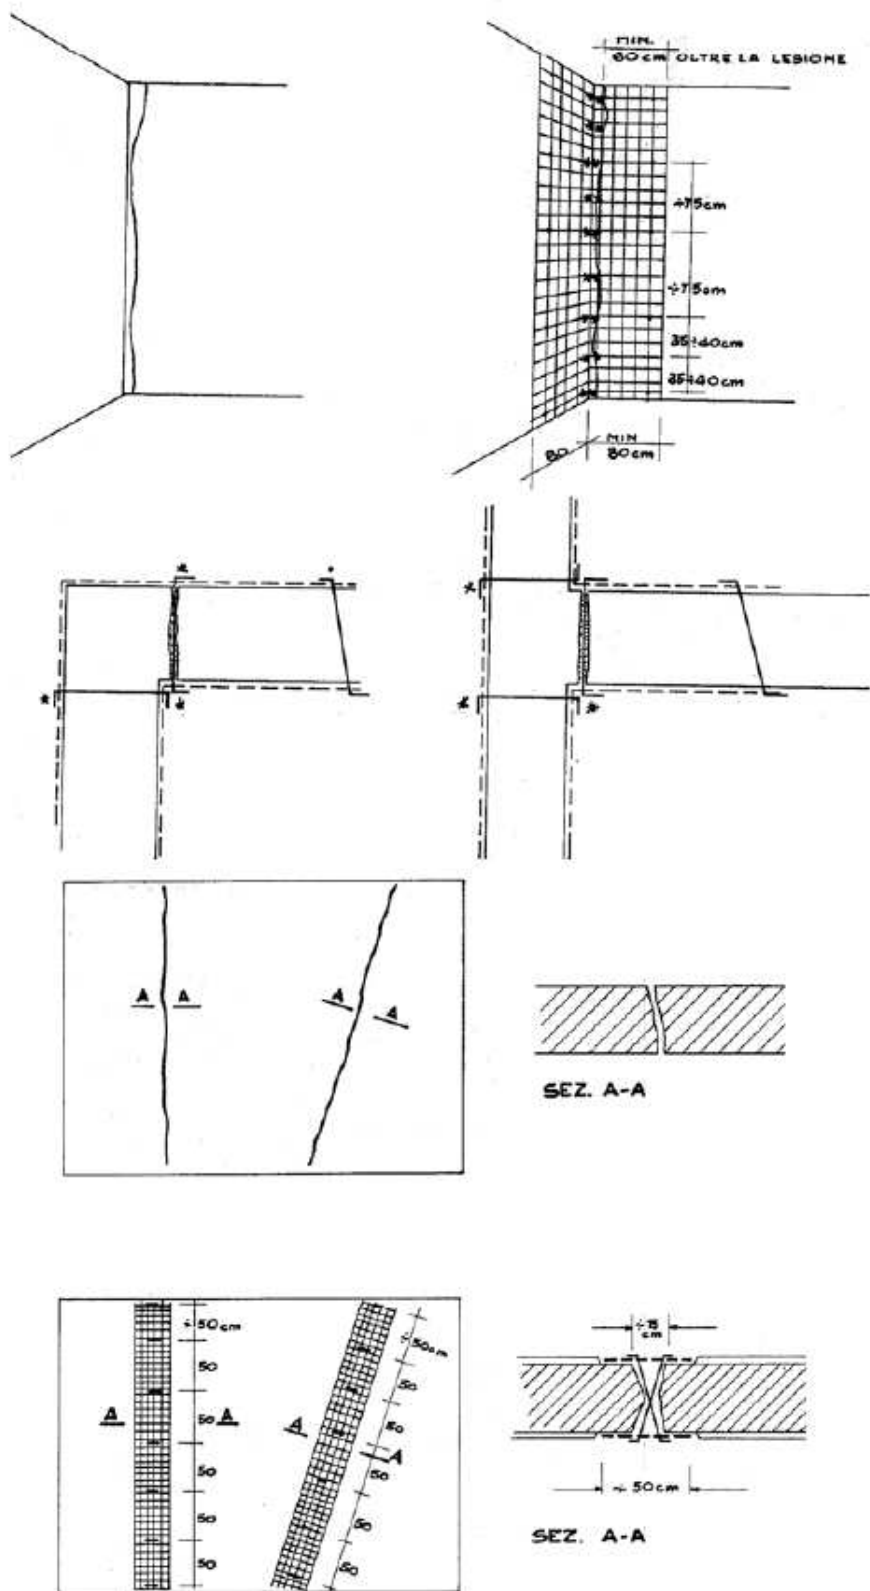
Applicazione di rete elettrosaldada nelle zone d'angolo e in corrispondenza di singole lesioni passanti
